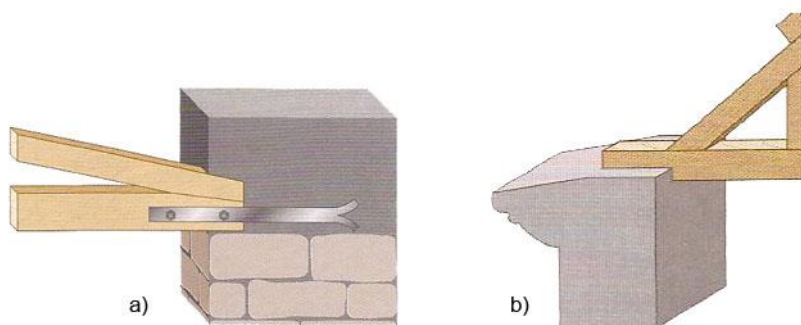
Tipos de apoios da estrutura da cobertura [18] ((a) Fixação das asnas à parede resistente por elementos metálicos; b) Apoio directo sobre consola de pedra)
